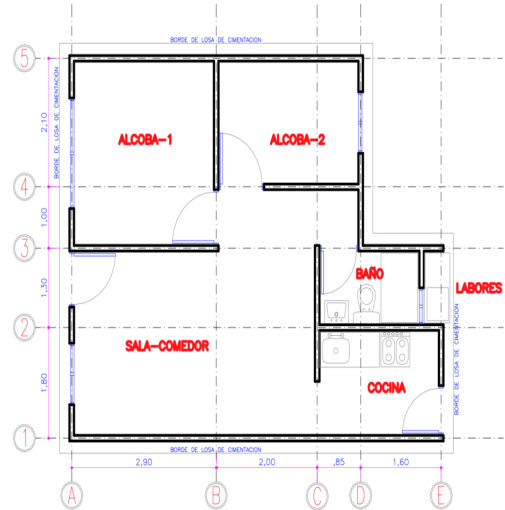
planta modelo a aplicar medición en el Sistema Constructivo paneles en fibrocemento. Fuente: Sistema de elementos prefabricados para muros, 2010.
